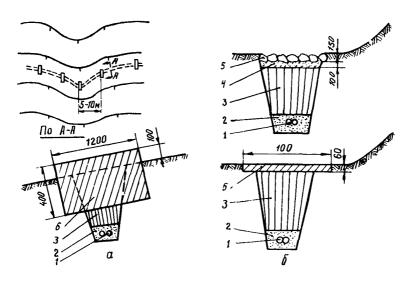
Защита траншем от размывания на поперечном уклоне: а — при уклоне 5-15°; б — на спланированной полке; I — кабель; 2 — мягкий грунт; 3 — местный грунт; 4 — песчано-цементное основание; 5 — булыжник; 6 — железобетсиная плита
